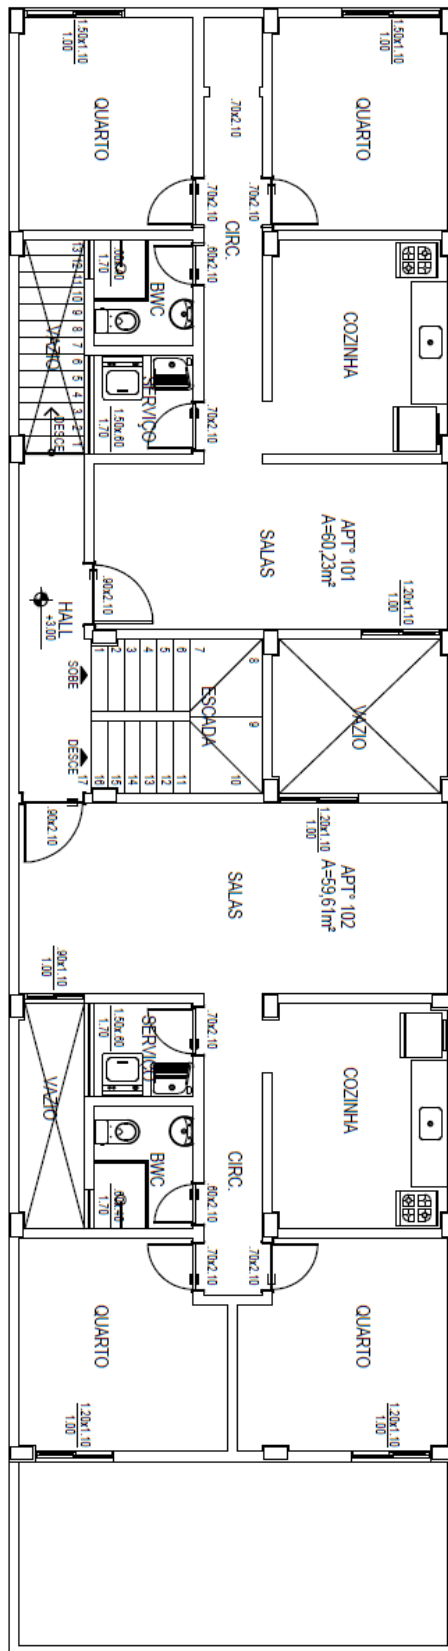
Planta Baixa Pavtº Térreo – EPP-4
